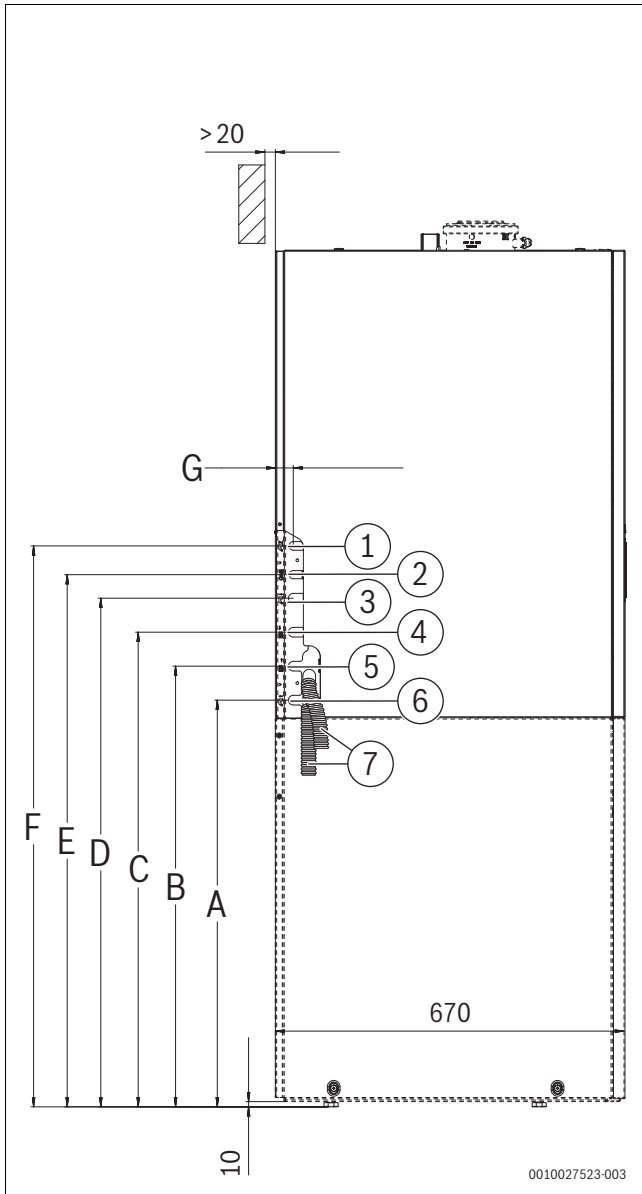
Vedere de pe partea stângă (dimensiune în mm)
